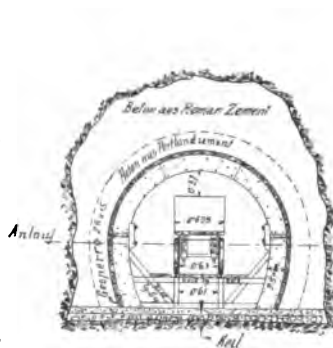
Einrüstung des Beacon Street-Tunnels.
